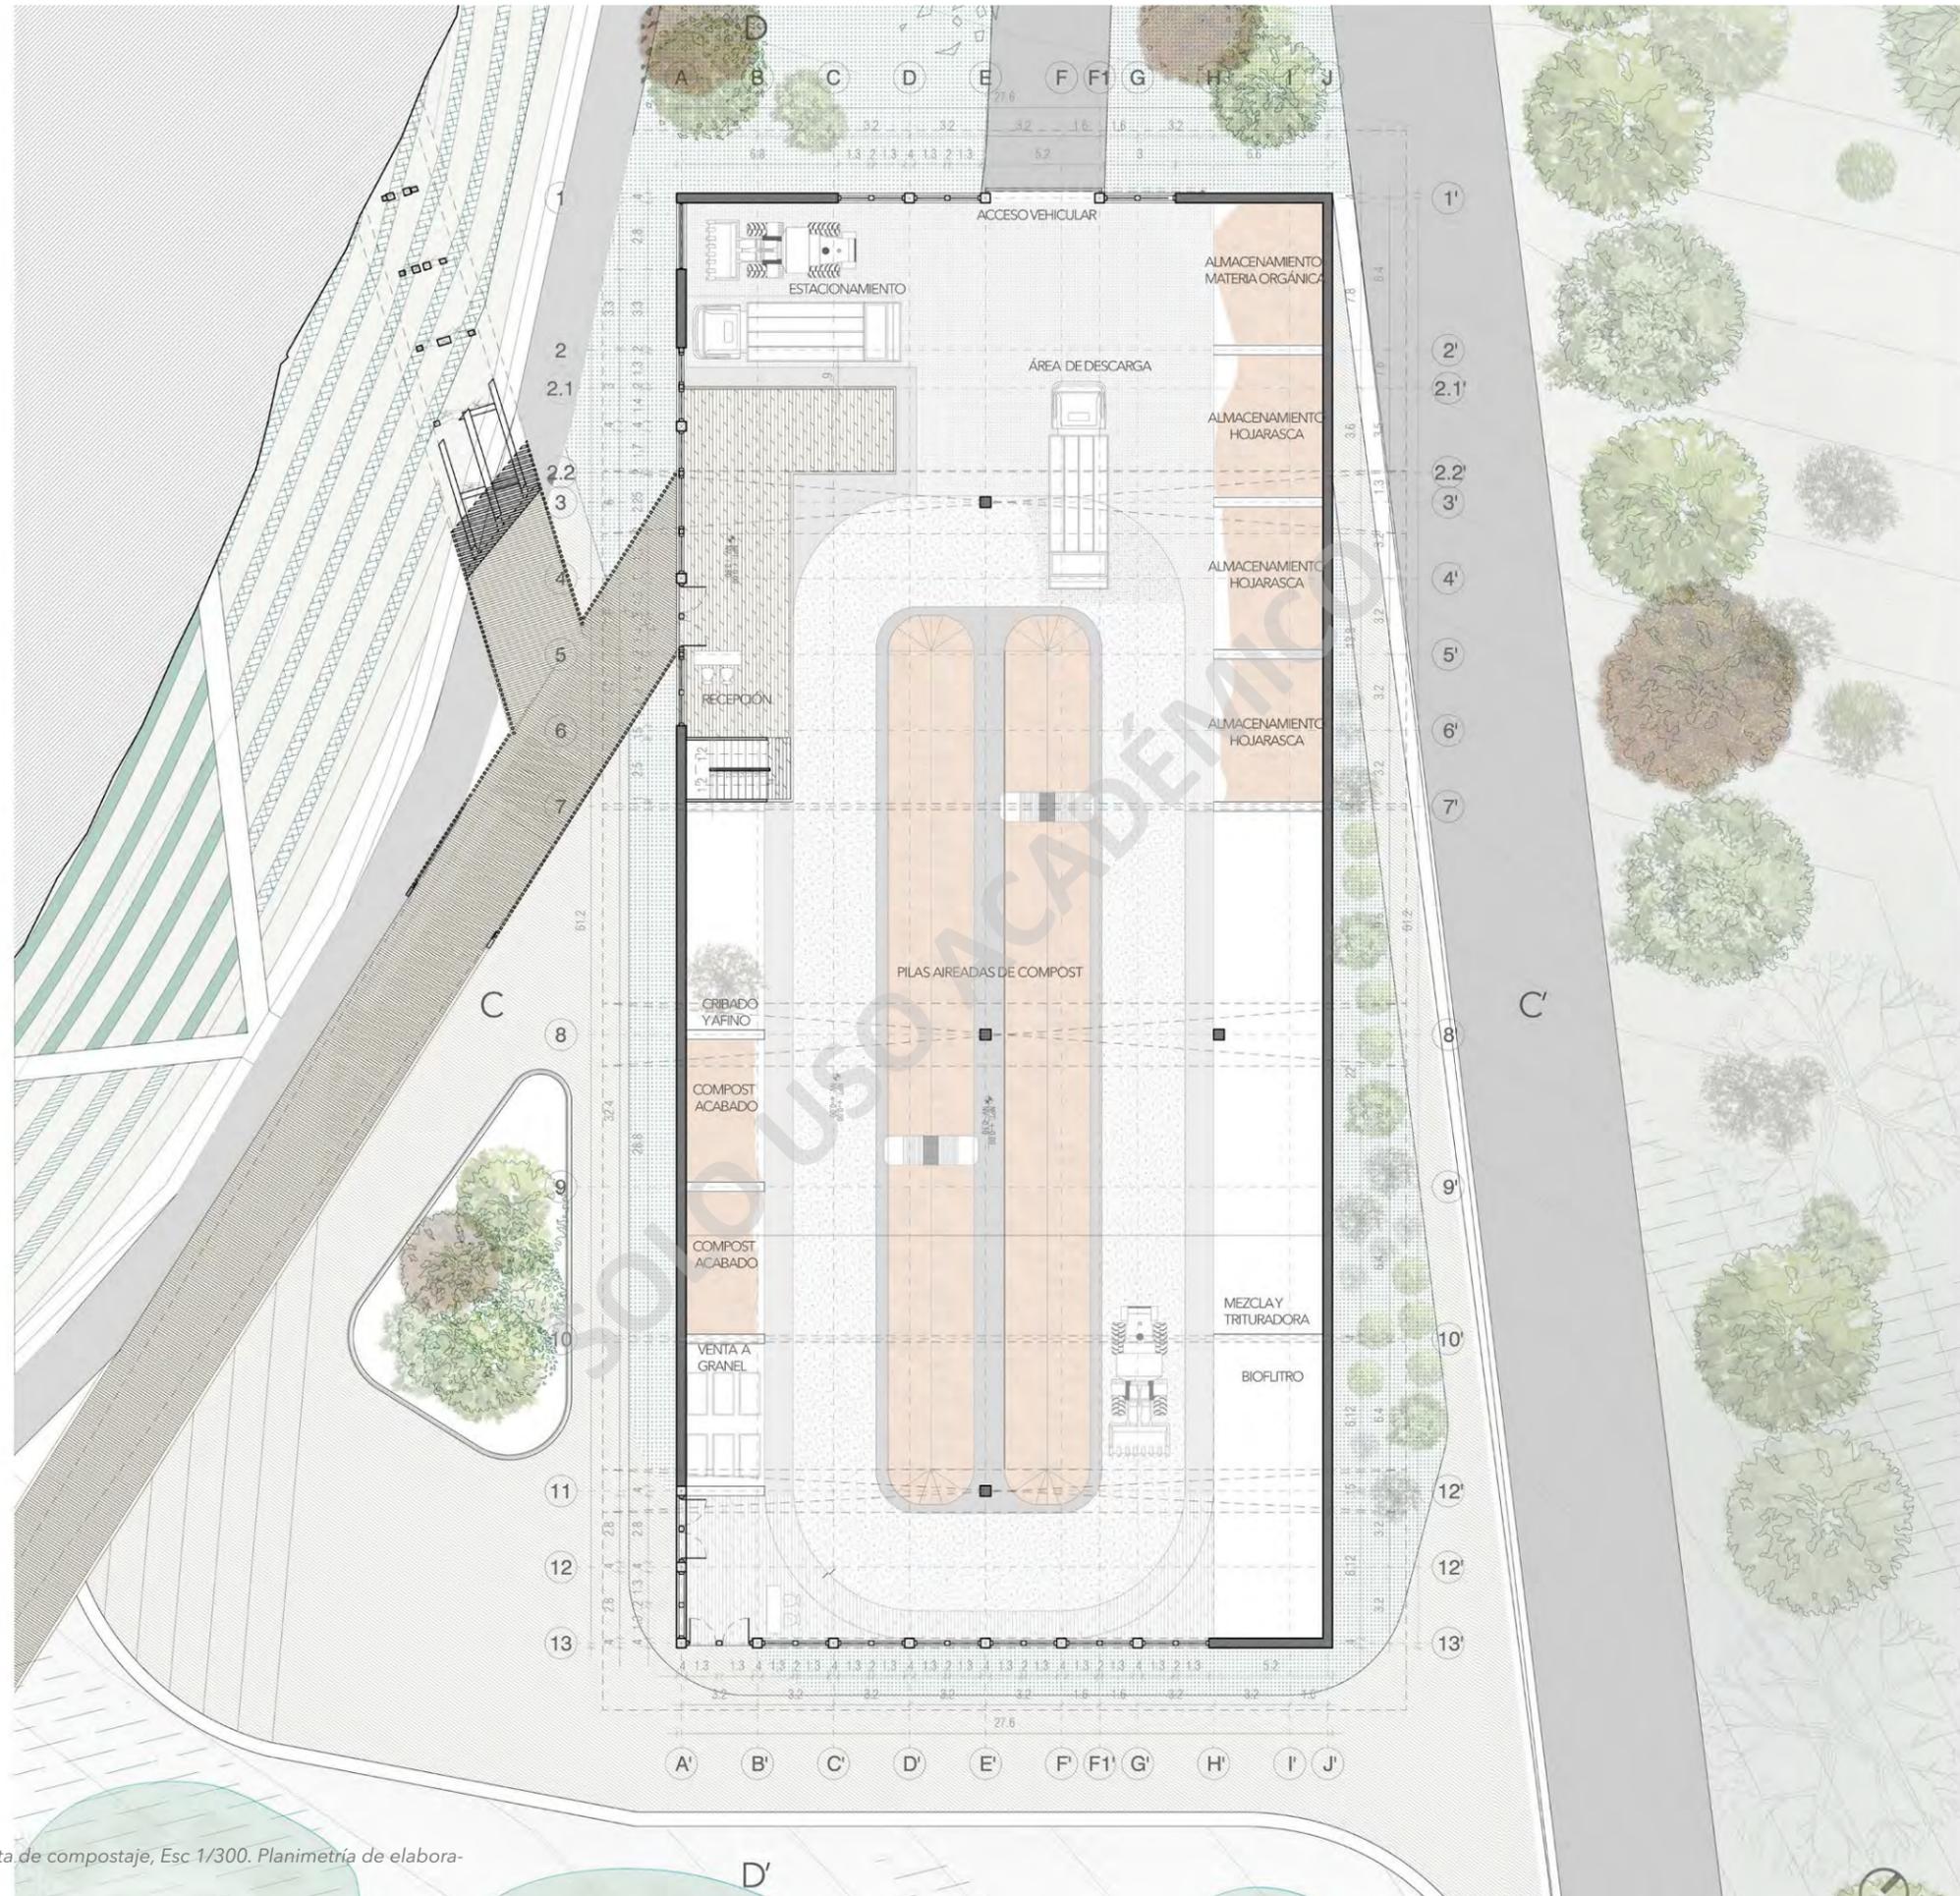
Planta de nivel dos / +3.50 de planta de compostaje, Esc 1/300. Planimetría de elaboración propia.
